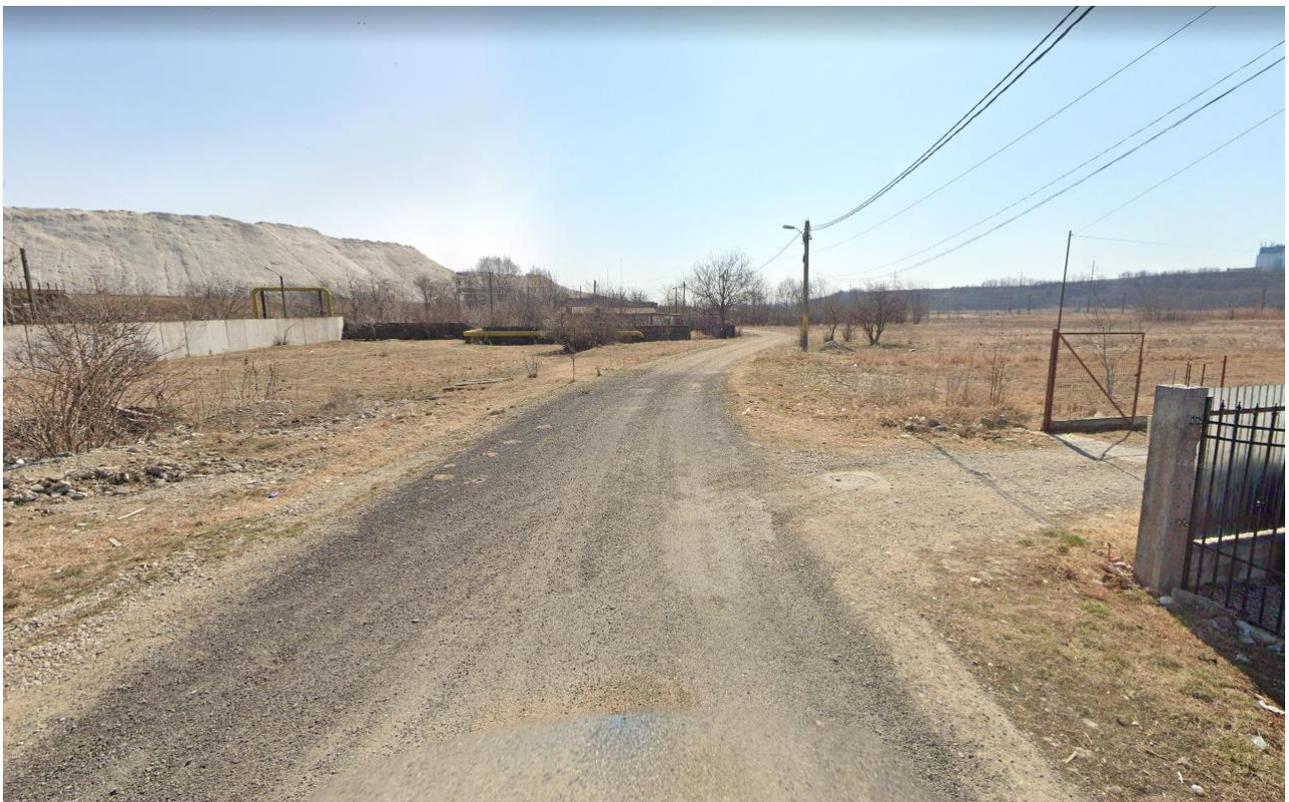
Amplasament existent Strada Ciresoia Tr. 1
